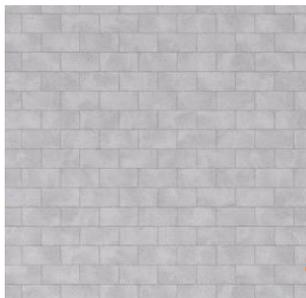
Sistema constructivo. Fuente: Torres del Bosque. Elaboración: Andres Idrovo.
